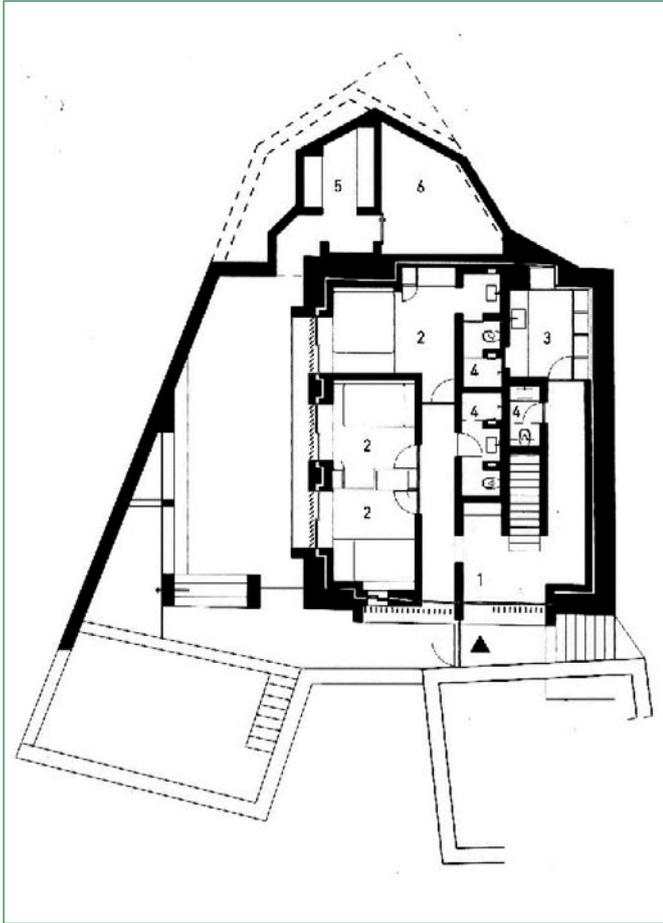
Grundriss Erdgeschoss: 1 Eingang, 2 Schlafen, 3 Waschküche, 4 WC/Dusche, 5 Abstellraum, 6 Technikraum
